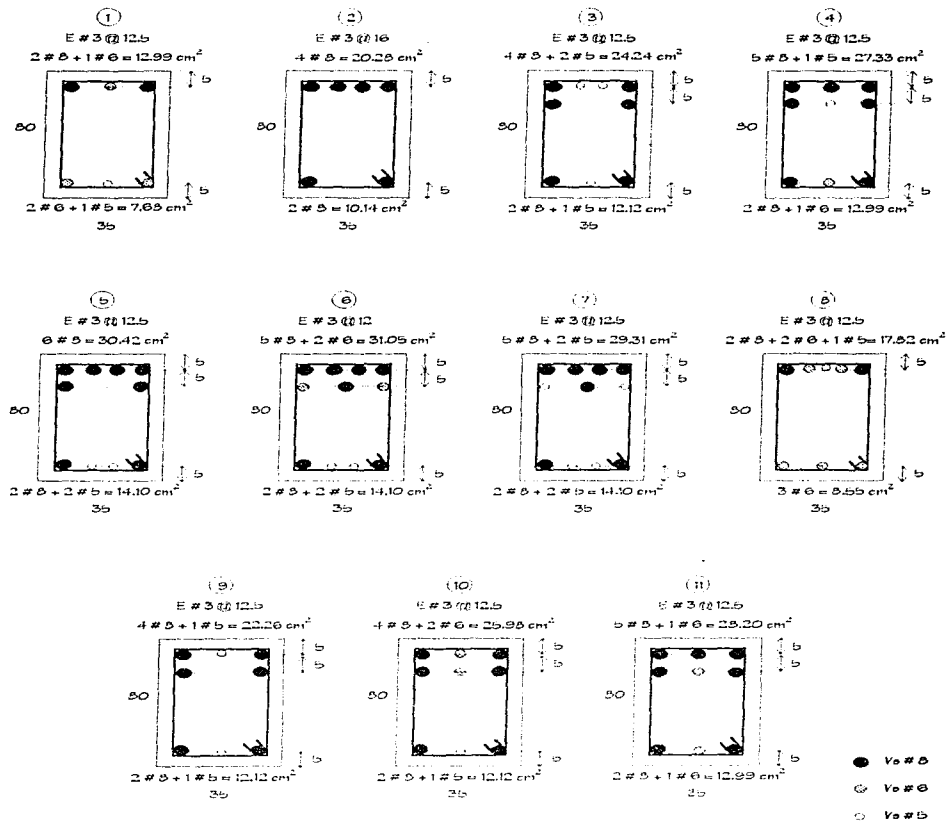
Tipos de armados de vigas del eje 2, edificio de 7 niveles diseñado en la zona III
